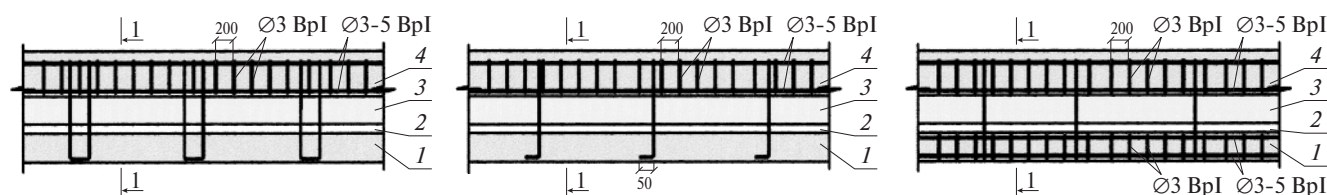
Схема установки нерегулируемых связей с анкеровкой к сетке: 1 – наружный слой кладки; 2 – воздушная прослойка; 3 – утеплитель; 4 – внутренний слой кладки
